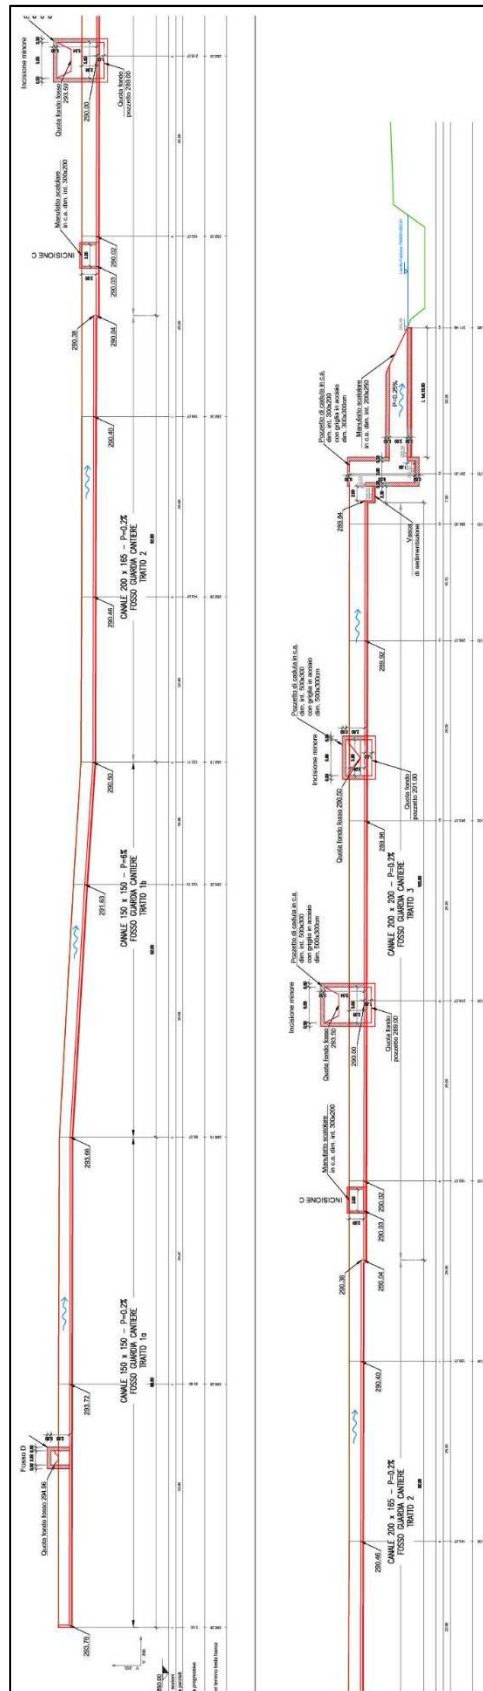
Canale di guardia Cantiere – Sezione longitudinale
